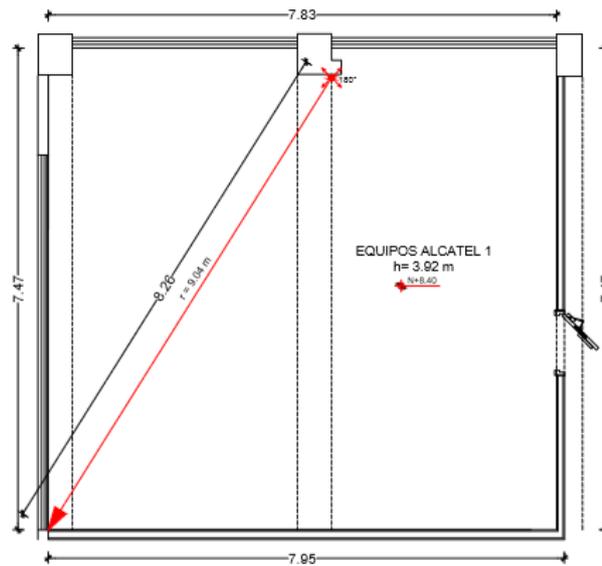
Plano de ubicación de tanque de agente limpio, tuberías y toberas de sala Alcatel nivel 1
